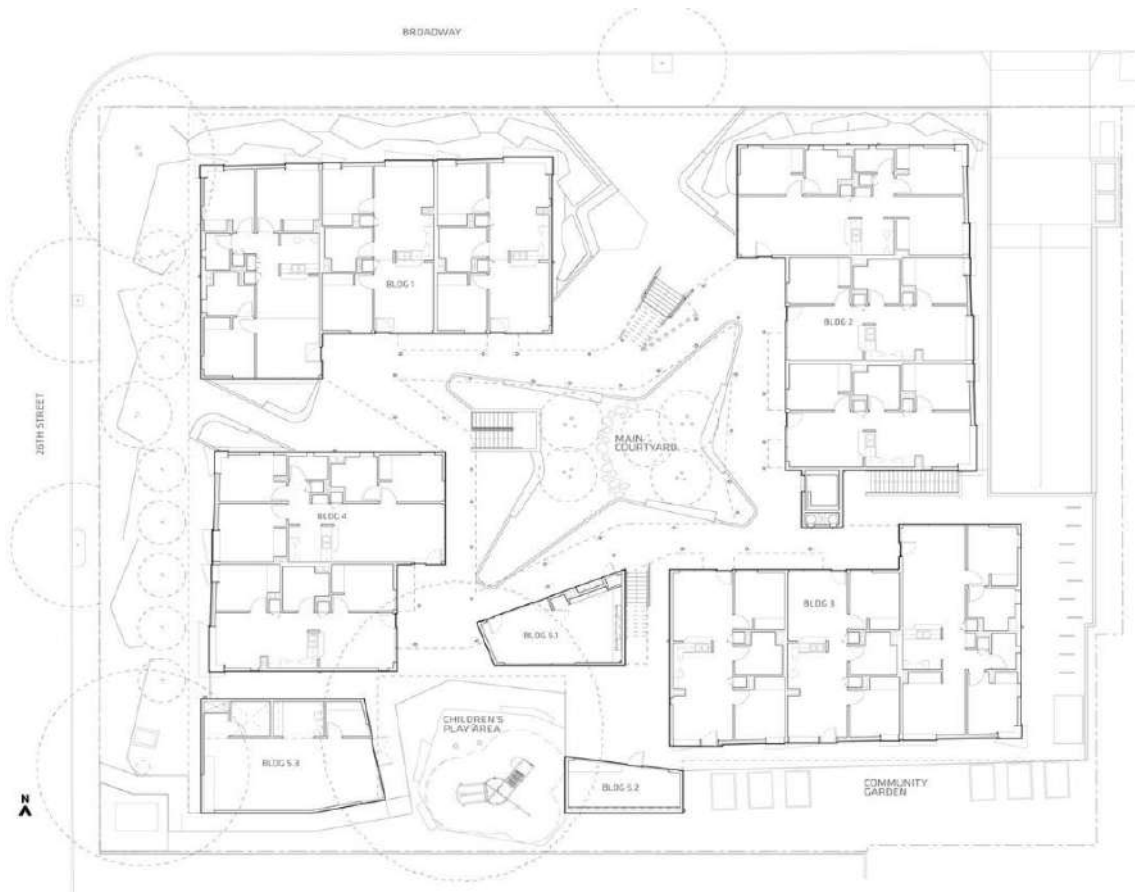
Схема генерального плану житлового комплексу Broadway Affordable Housing, <https://www.archdaily.com/503233/broadway-housing-kevin-daly-architects>
